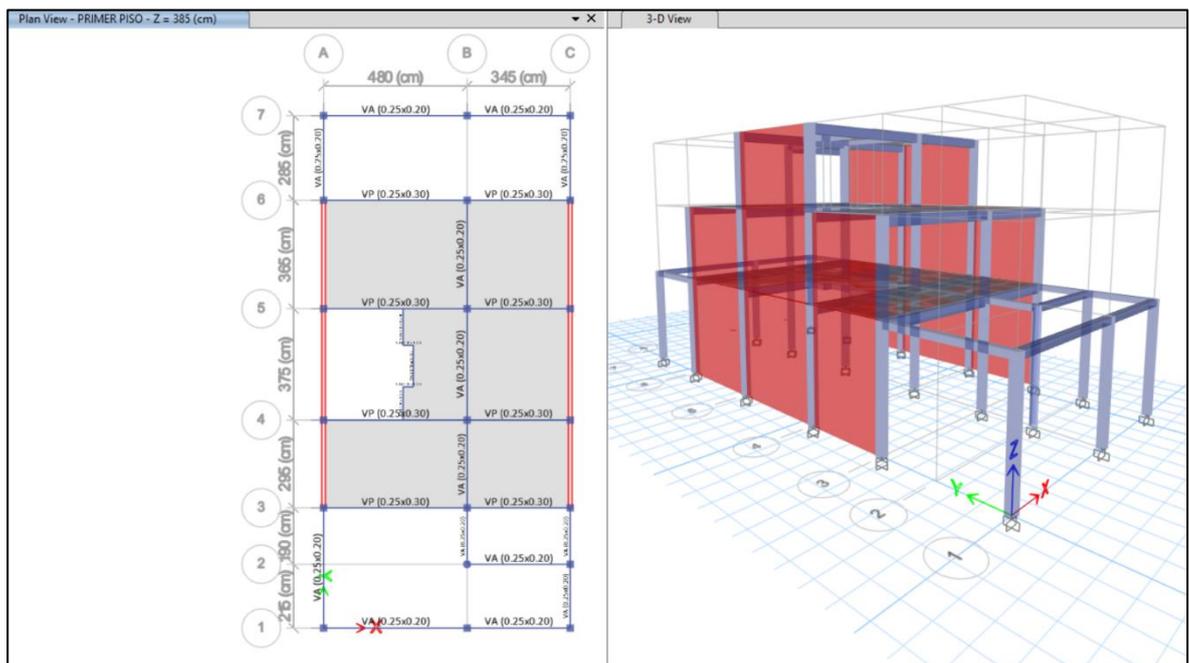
Modelamiento completo con el refuerzo en vigas, columnas y muros.
